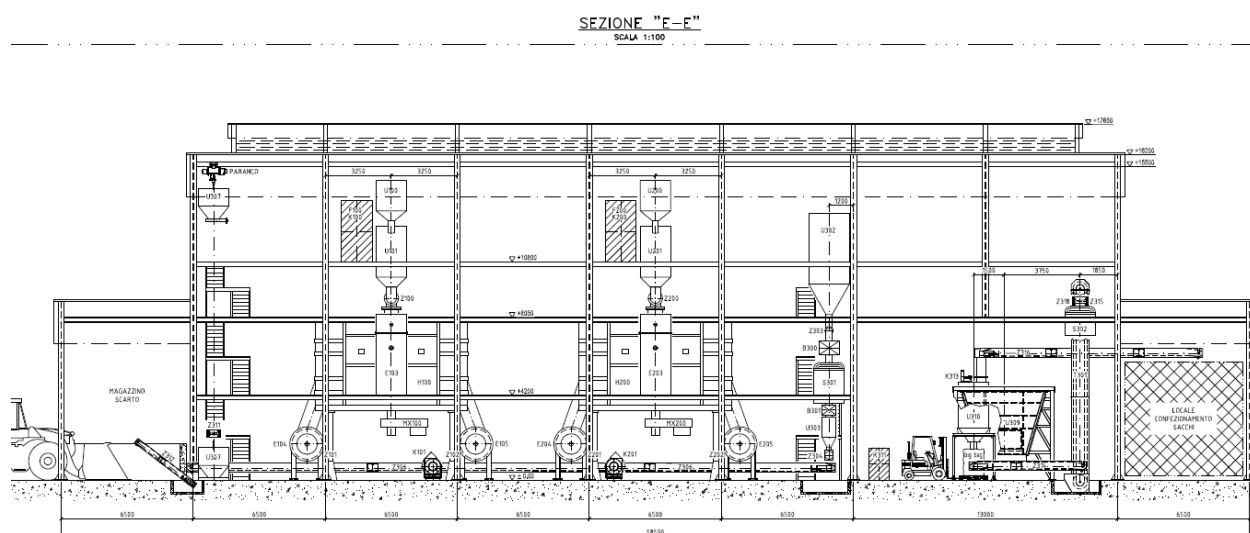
Progetto definitivo delle opere (sezione "E-E")
